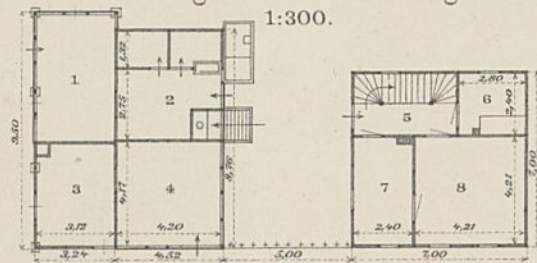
u. 6. Grundrisse des Erdgeschosses.
